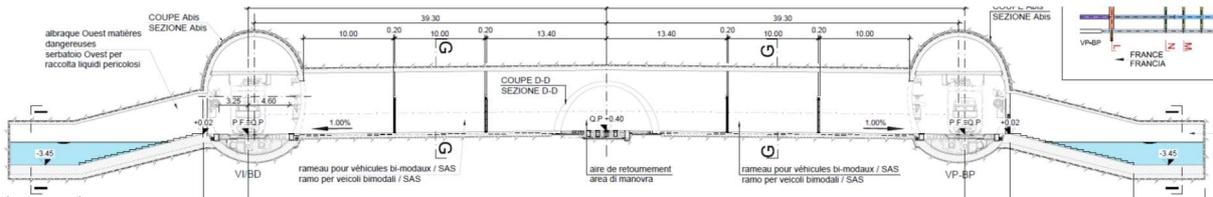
Ramo per veicoli bimodali Ovest: sezione trasversale [28]
